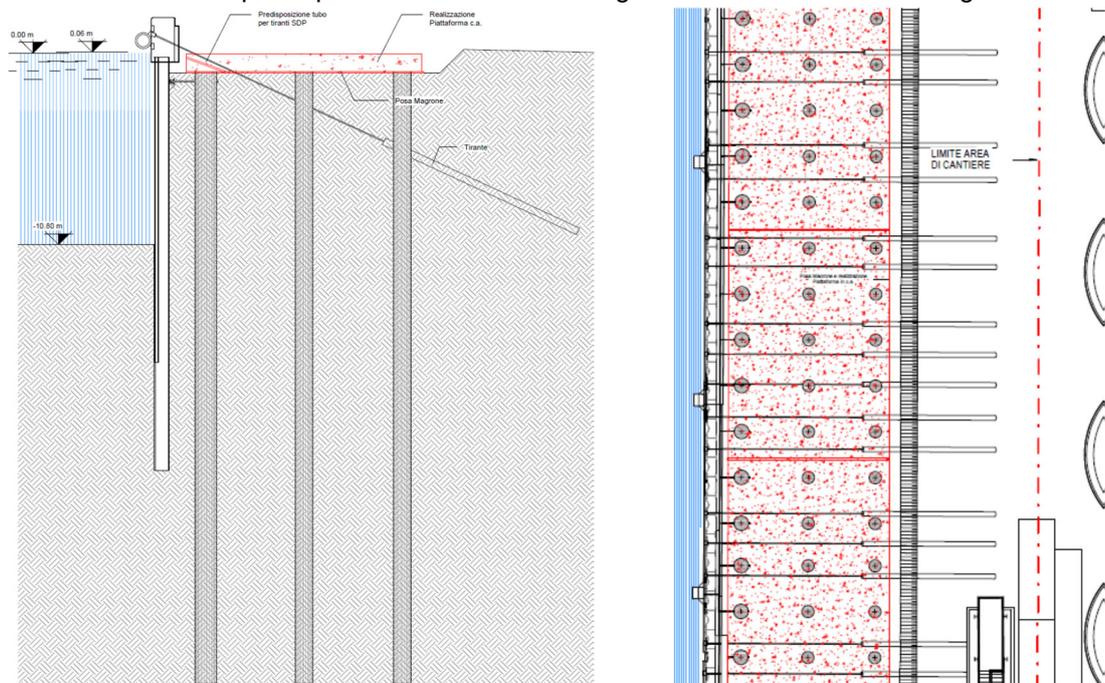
Banchina Bunge Sud – Fase 6 – Sezione e planimetria
